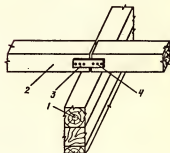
Схема соединения балок междуэтажного перекрытия на внутренней стене:
